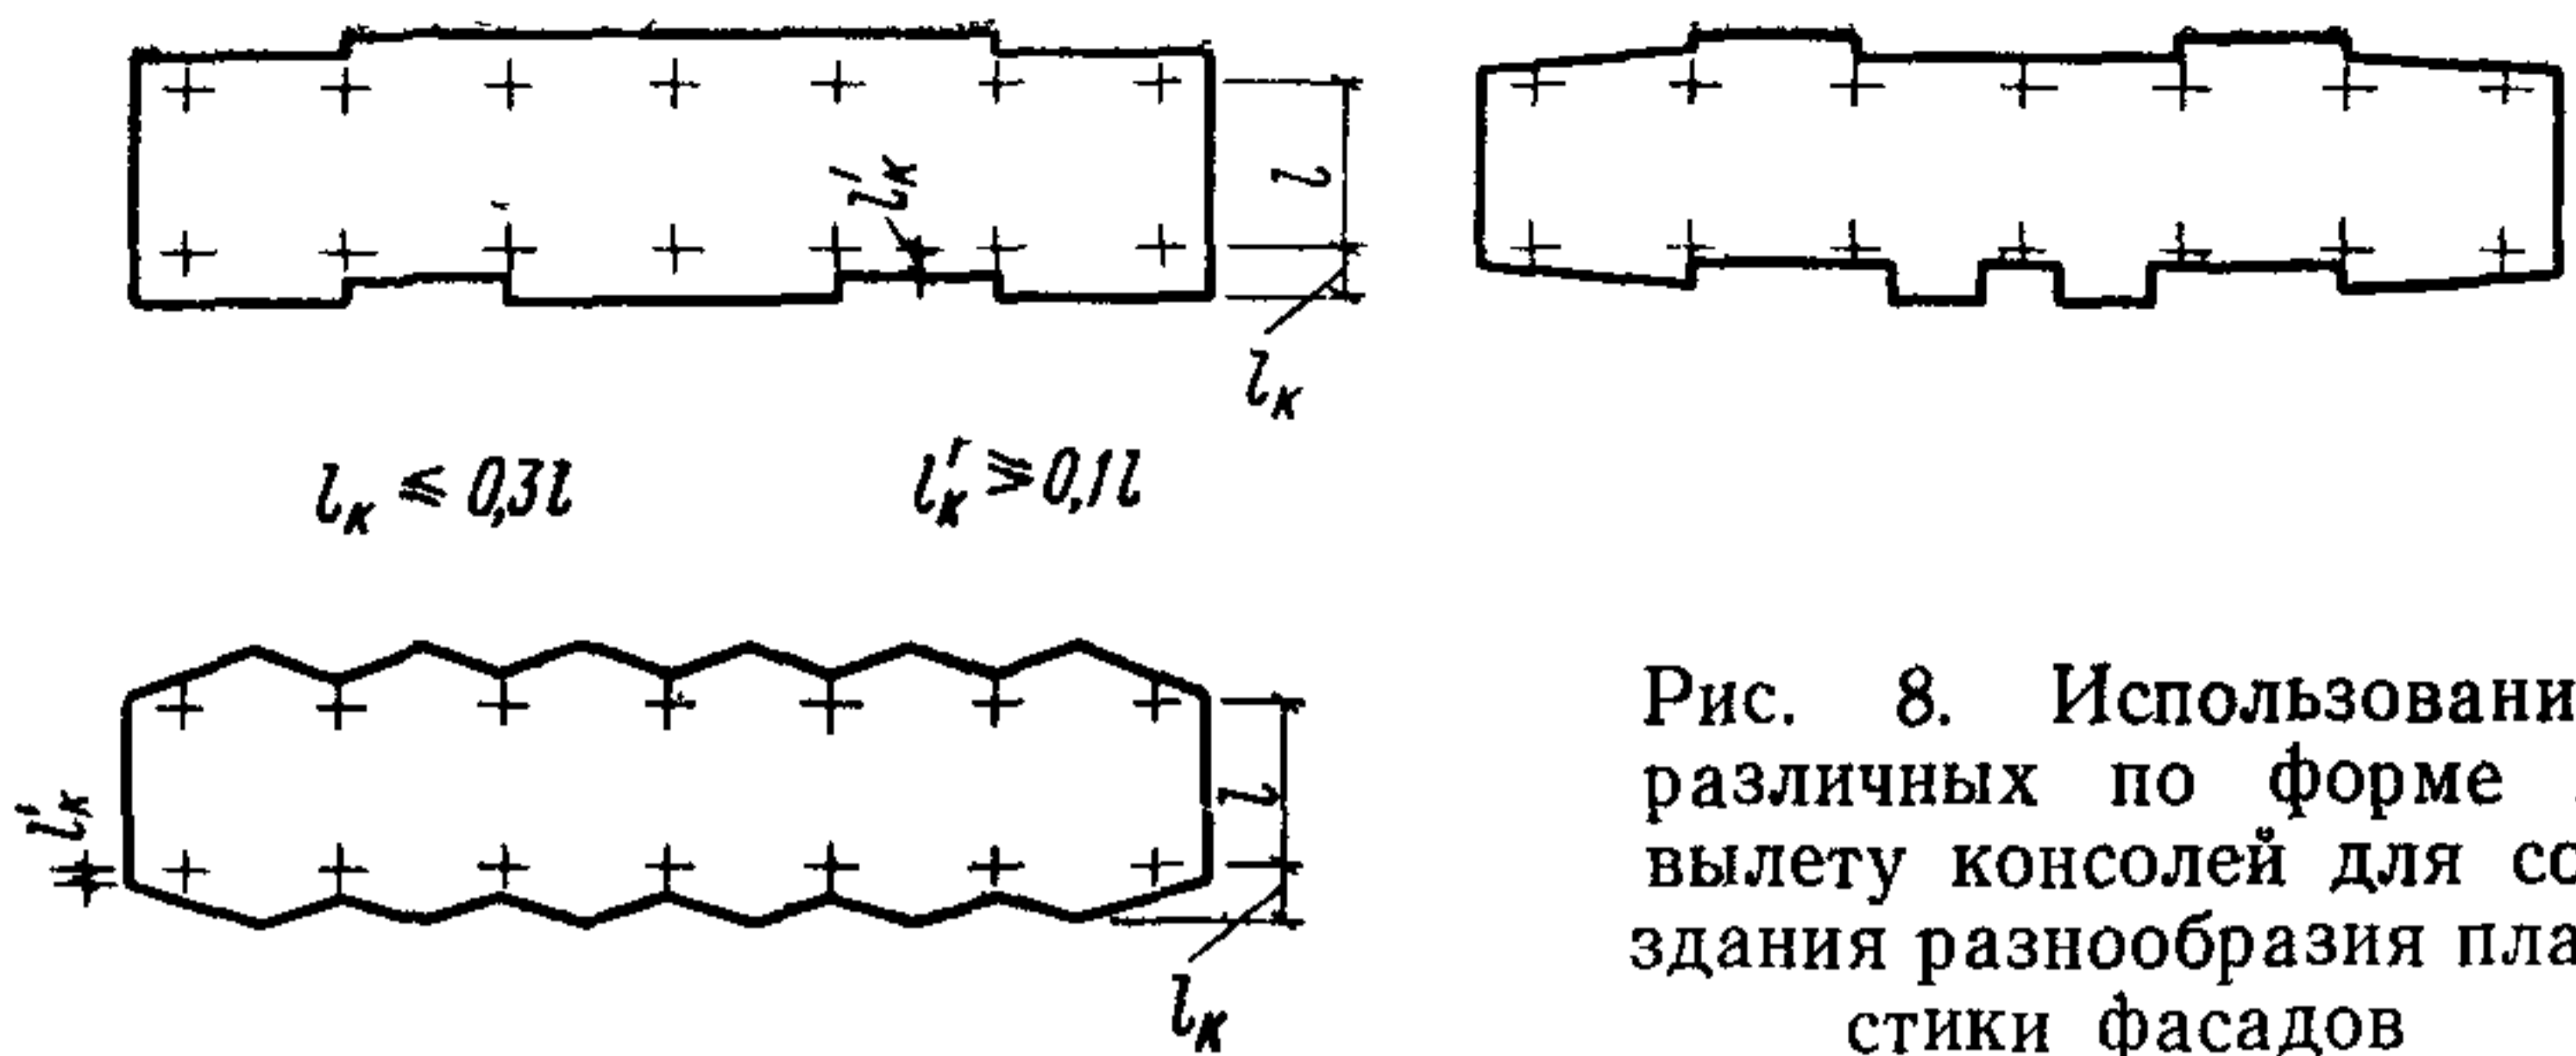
Использование различных по форме и вылету консолей для создания разнообразия пластики фасадов
